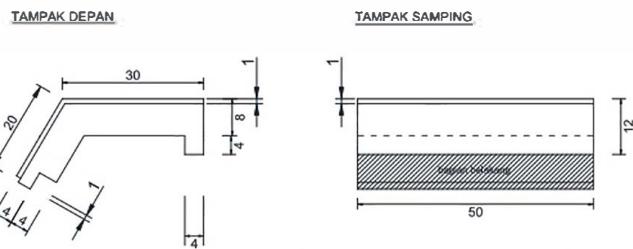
Modul Dinding atau Lantai Tipe-S Beton Pracetak Modular
